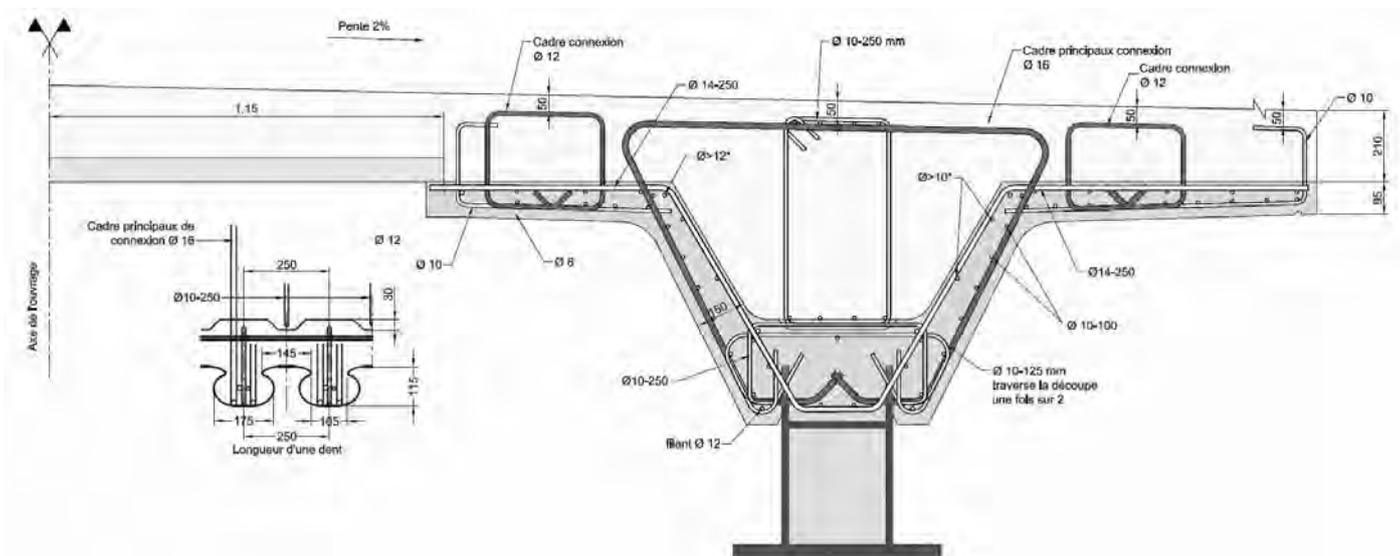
Coupe transversale à l'encastrement les aciers longitudinaux d'ancrage ne sont pas figurés
